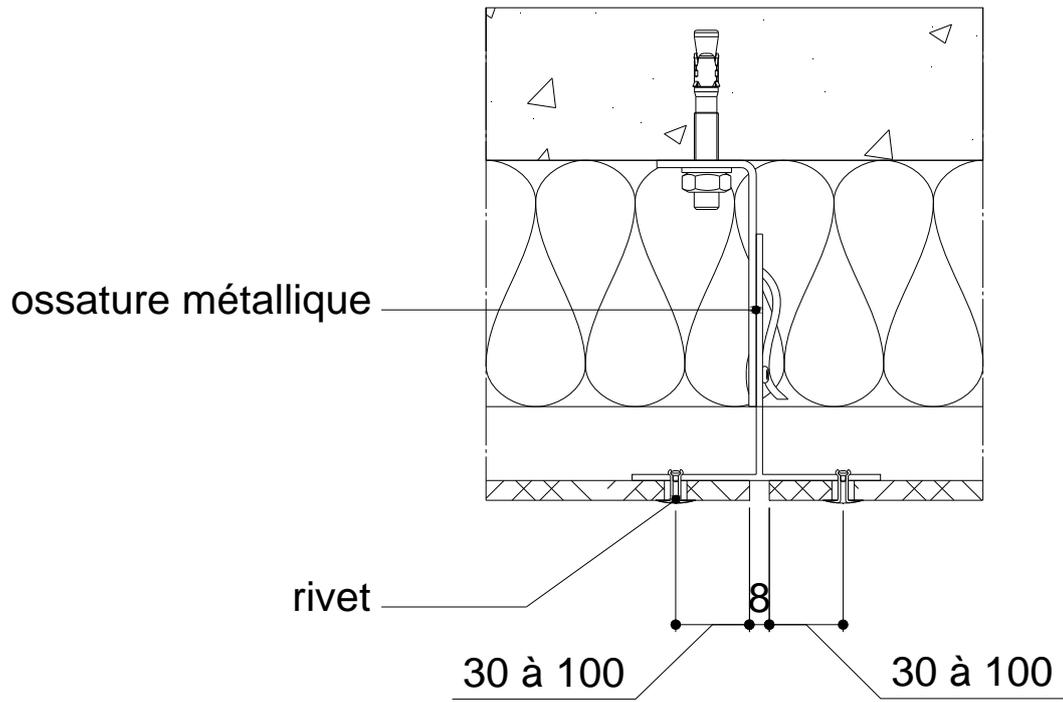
Joint vertical (coupe horizontale) sur ossature métallique (cote en mm)
